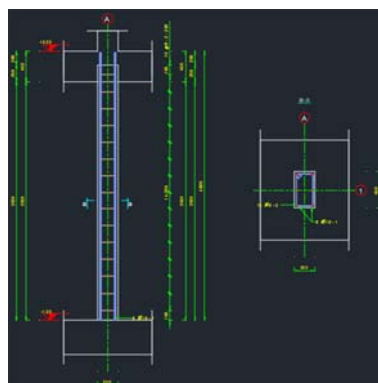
Resultado da transferência para Autocad Structural Detailing
